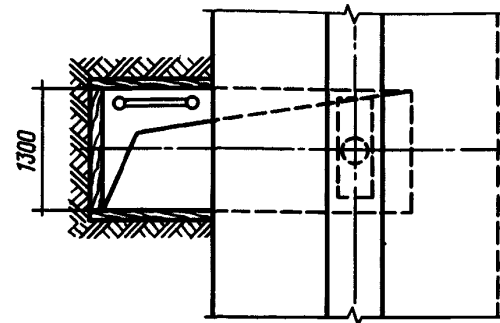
Вдавливание свай под фундаментом или свайным роствергом:
